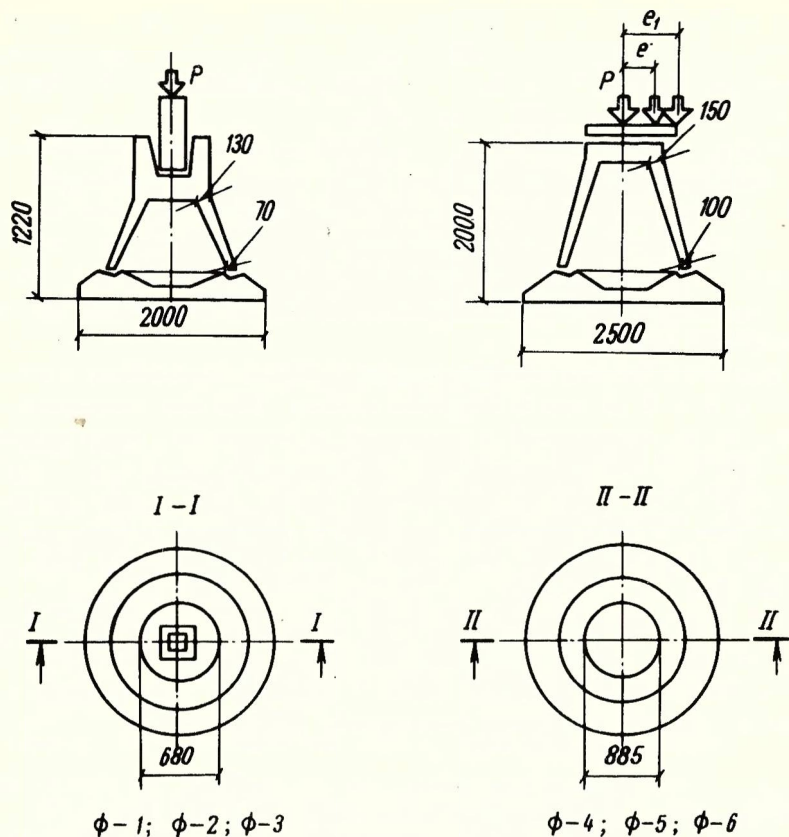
Геометрические размеры натуральных фундаментов и схема приложения нагрузки при испытаниях
